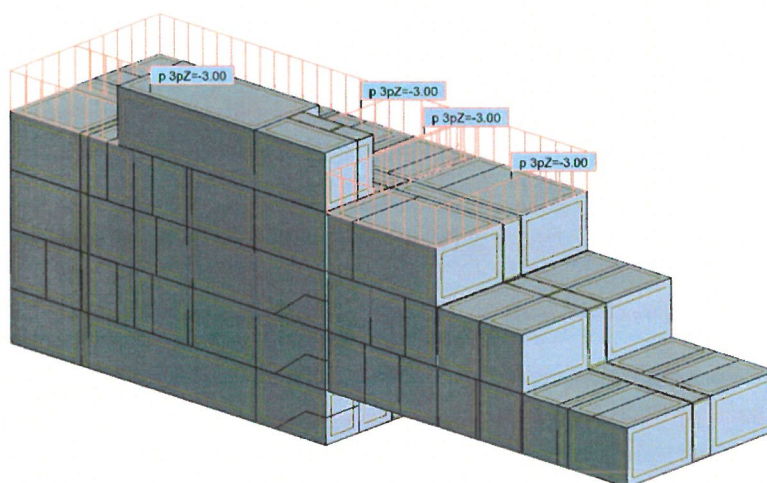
Przypadek obciążenia użytkowego od dachu intensywnego.
